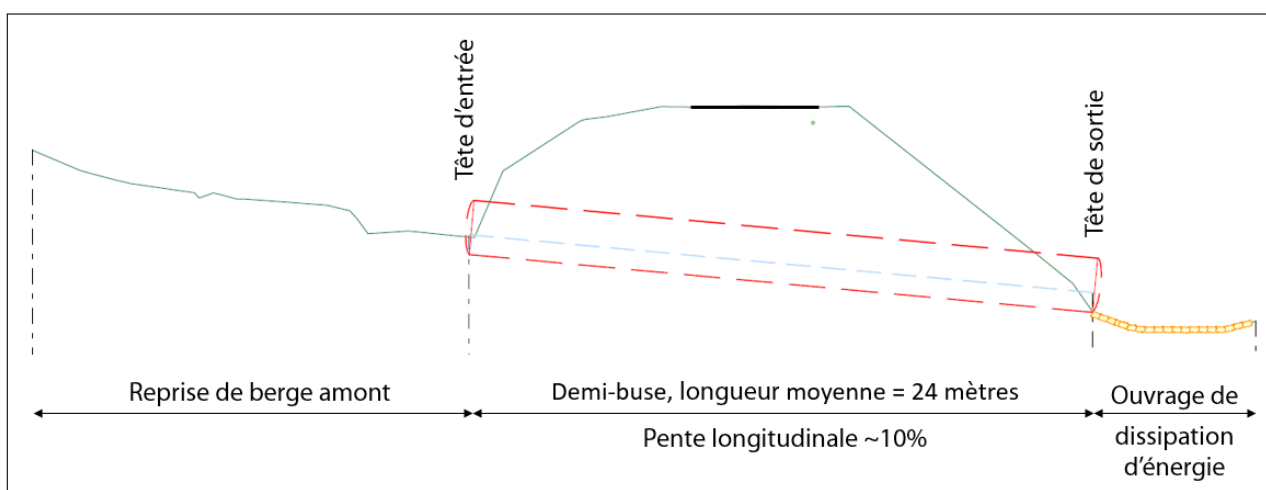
Evaluation 1, installation d'une demi-buse, profil en long
